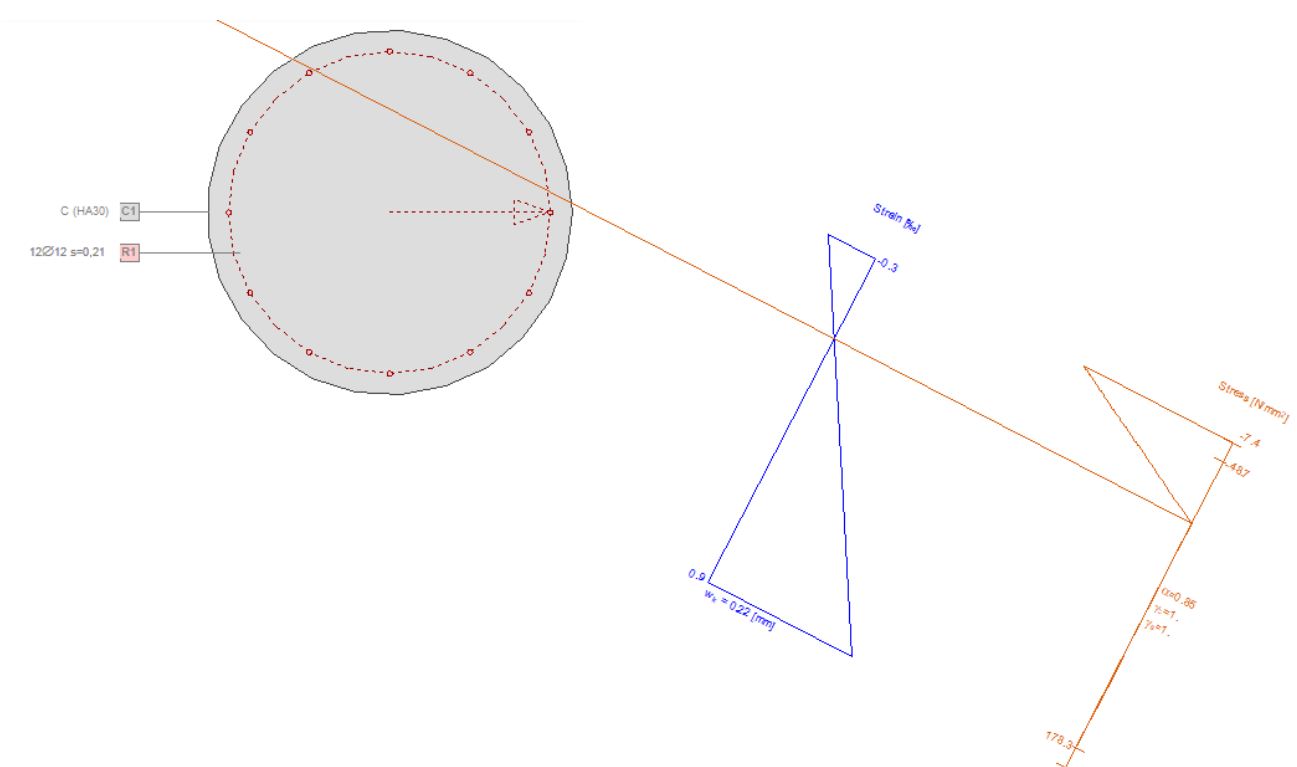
Càlcul de fissuració màxima dels pilons de la piles 4, 5 i 6
